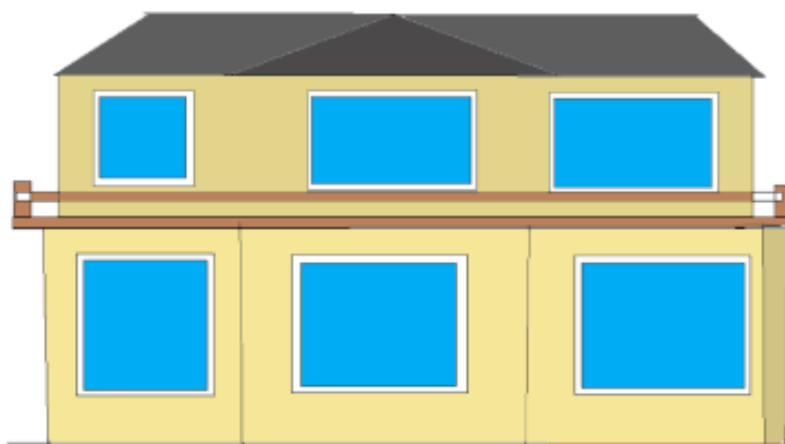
Решение фасадов жилого дома (северный фасад)
